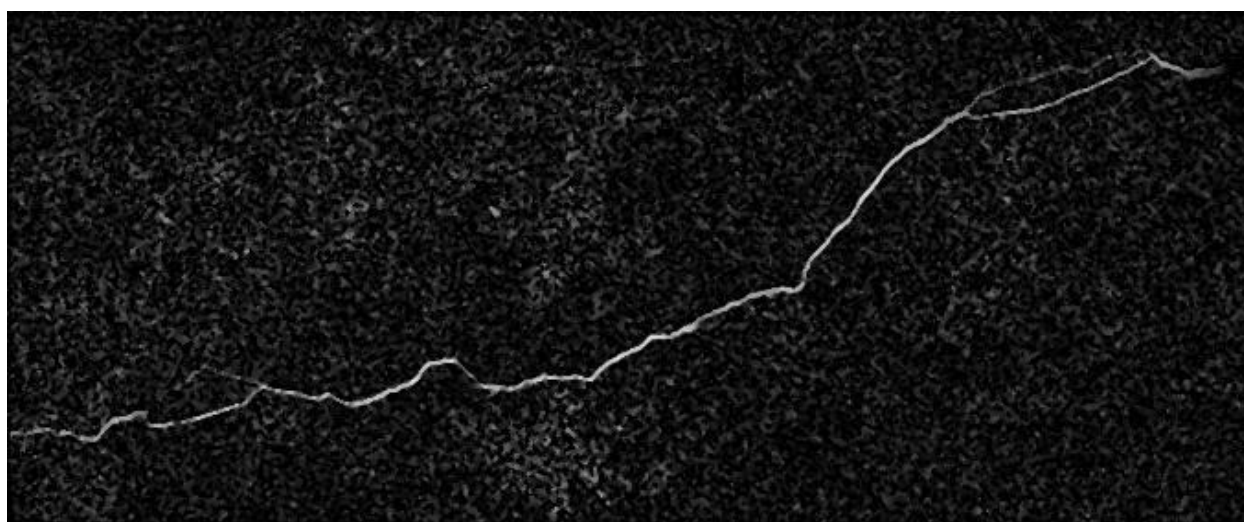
Exemplo de Aplicação 3 (Fissuras) – Imagem Processada.
